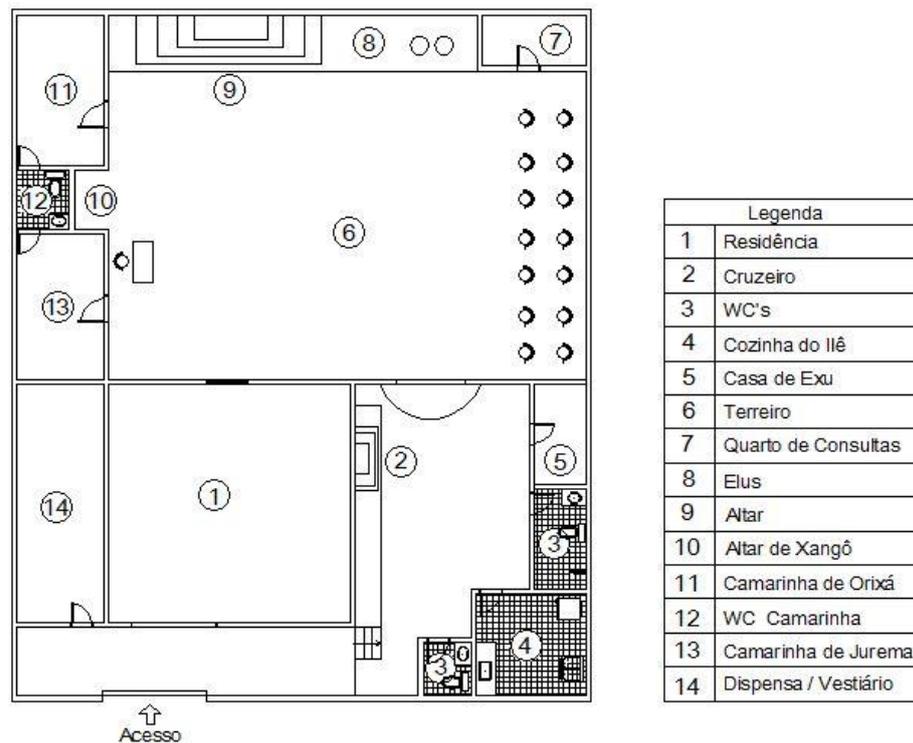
Planta baixa do Ilê Axé Xangô Agodô.
